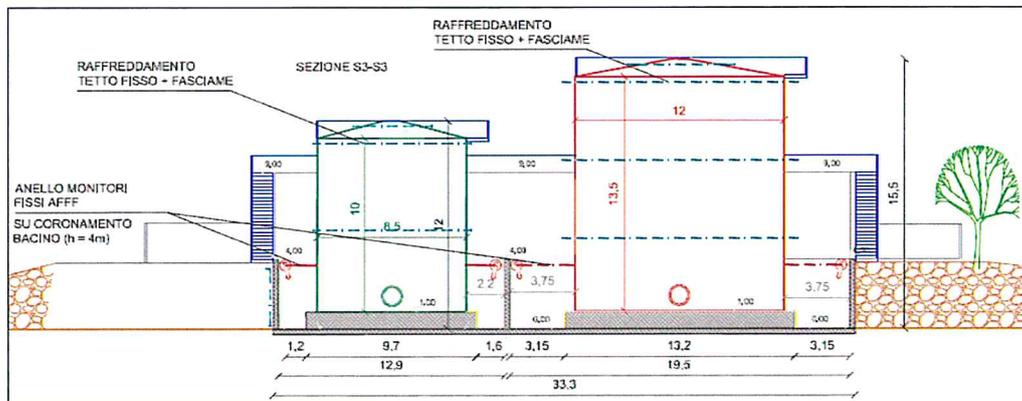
Prospetti di progetto (da Elab. T10 allegato allo SPA)
